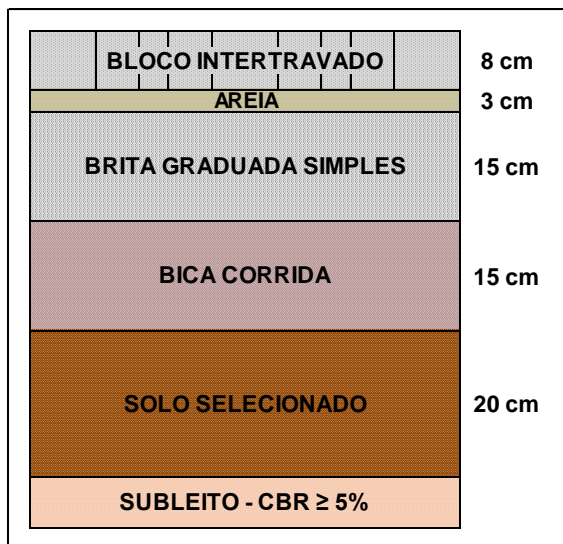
Estrutura Proposta para o Pavimento Intertravado.
